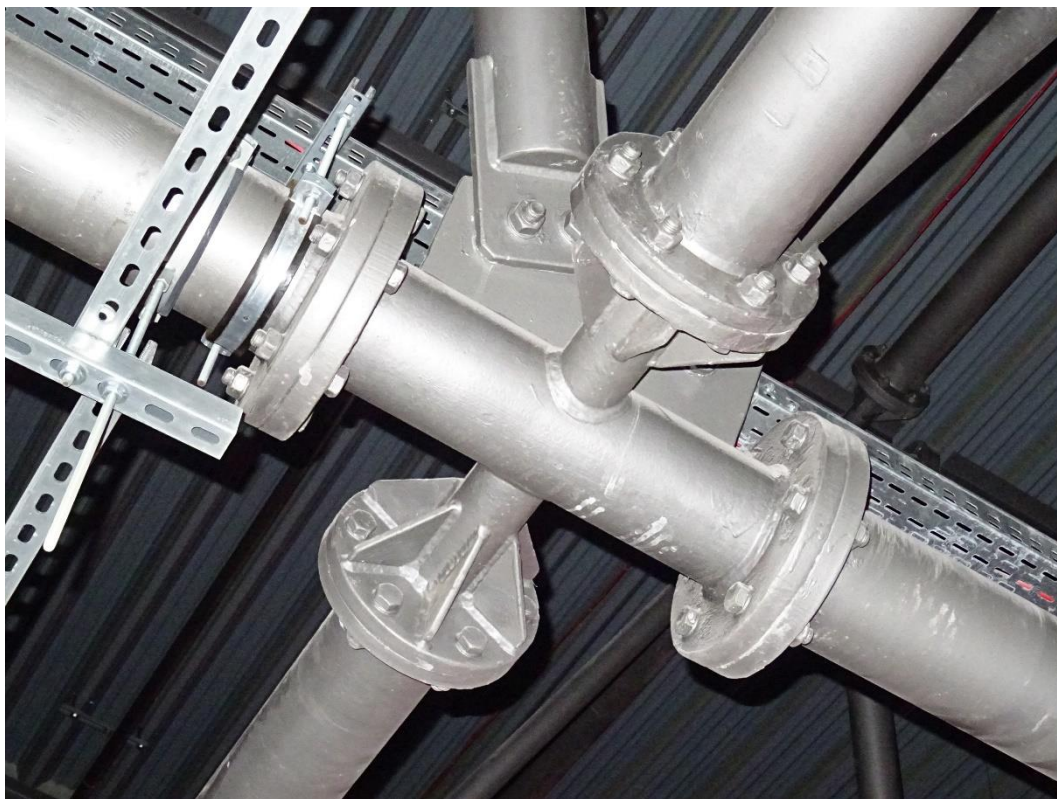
Konstrukcja dachu – krawędź świetłówka przy podporze północnej
